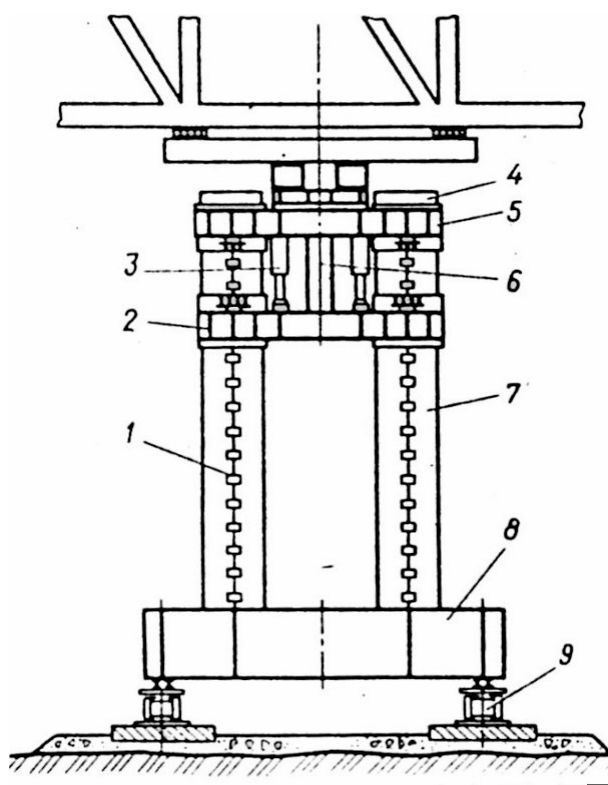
Фермоподъемник, применяемый при реконструкции мостов:
